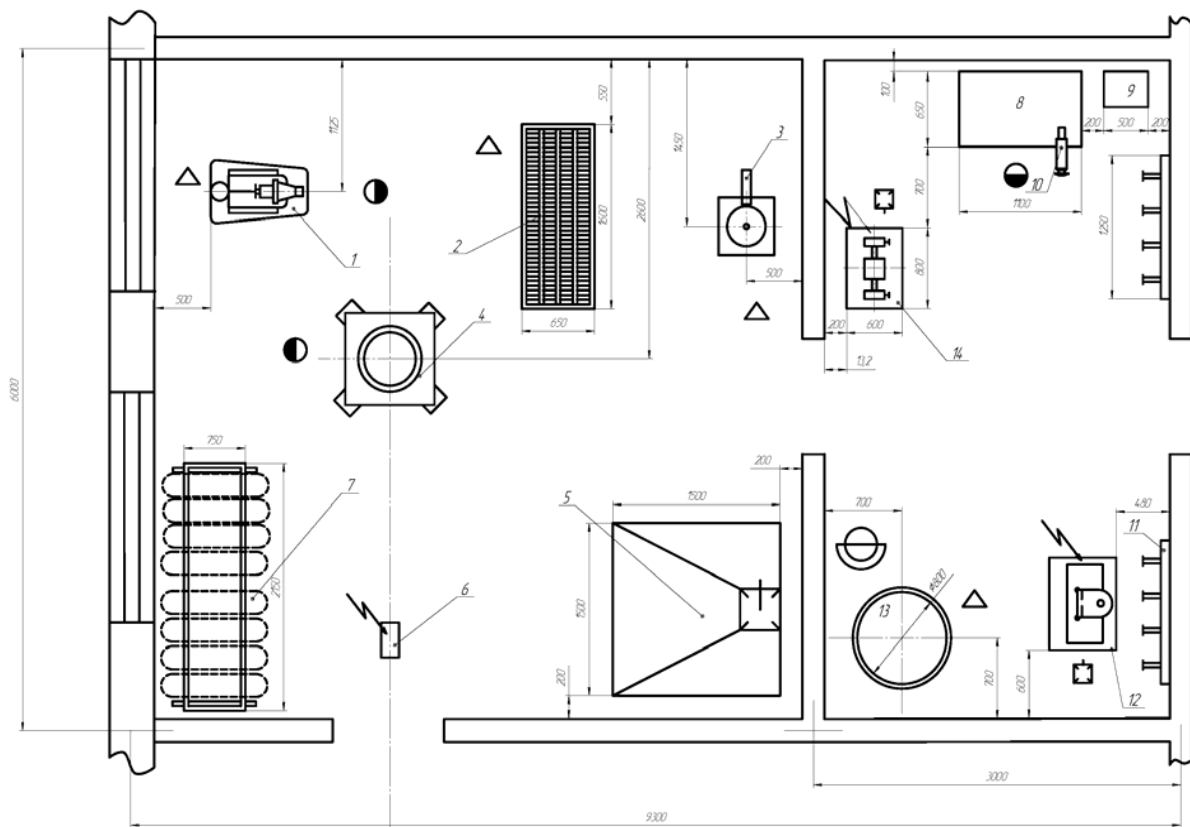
Шиномонтажный и вулканизационный участок: 1 – пневматический борторасширитель; 2 – клеть для накачки шин; 3 – стенд для правки дисков колес; 4 – стенд для демонтажа и монтажа шин; 5 – камера для окраски дисков колес; 6 – электротельфер; 7 – одноярусный стеллаж покрышек; 8 – верстак; 9 – ларь для отходов; 10 – слесарные тиски; 11 – настенные вешалки для камер; 12 – электровулканизационный аппарат для ремонта камер; 13 – ванна для проверки камер; 14 – шероховальный станок
